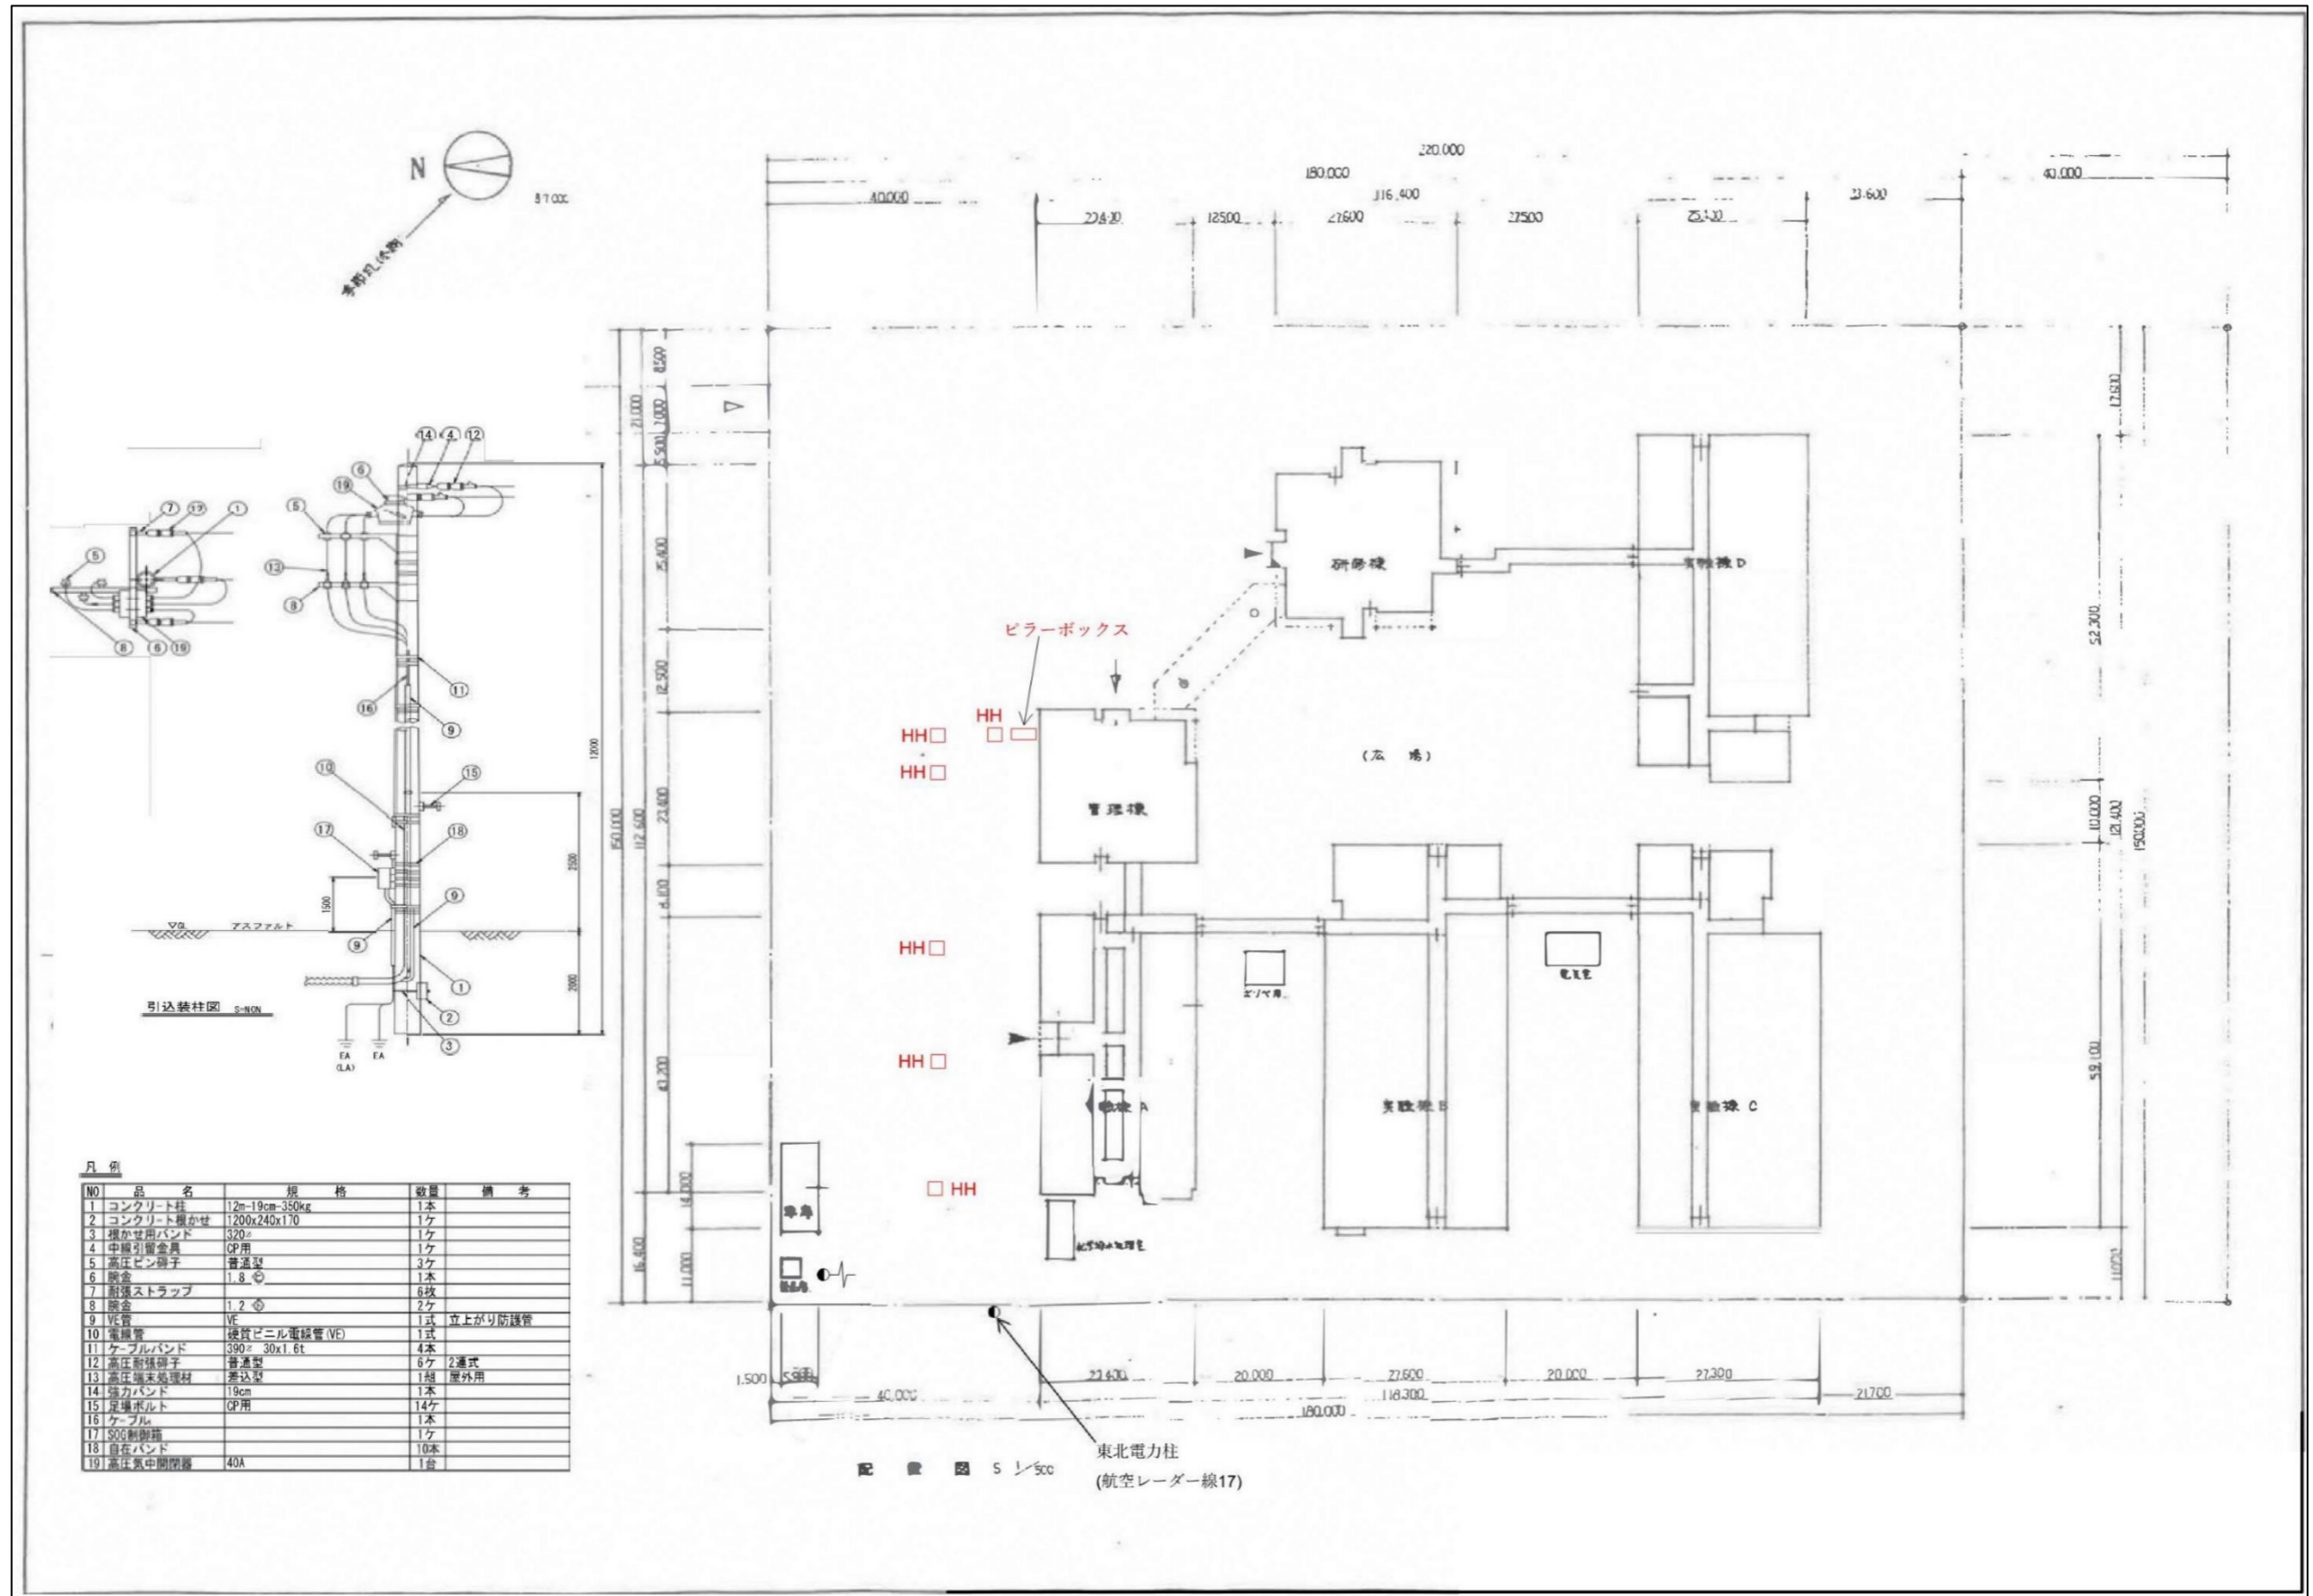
産業技術センター平面図 (ピラーボックス設置位置案)
